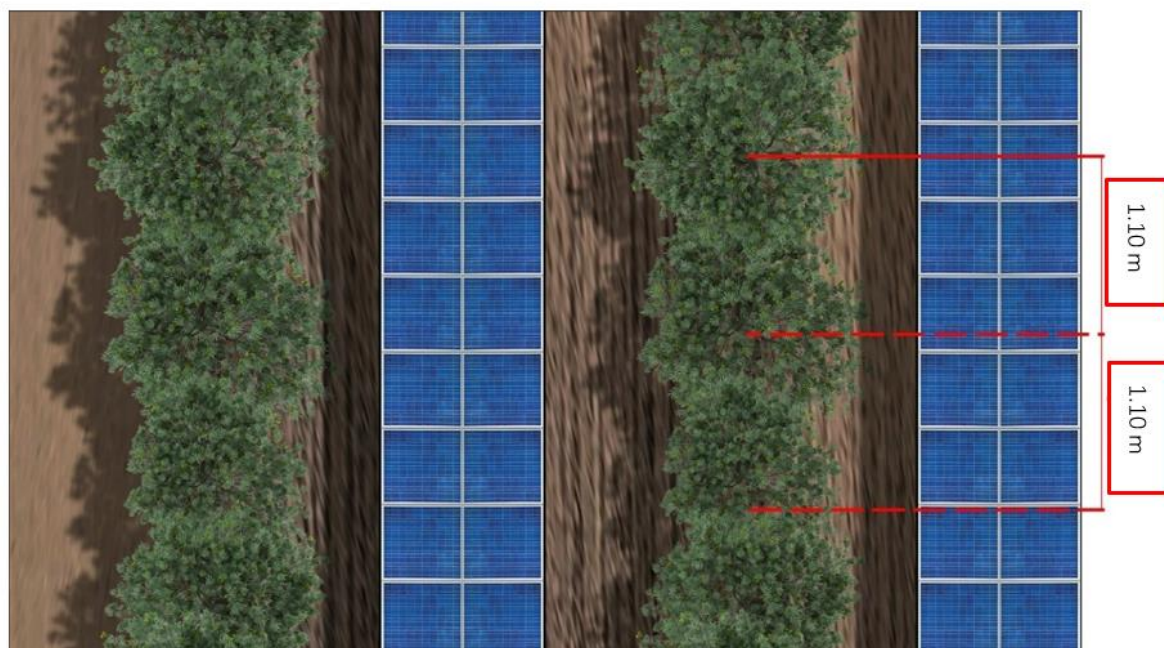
Tipologico – Vista Planimetrica dell’impianto Olivicolo.
